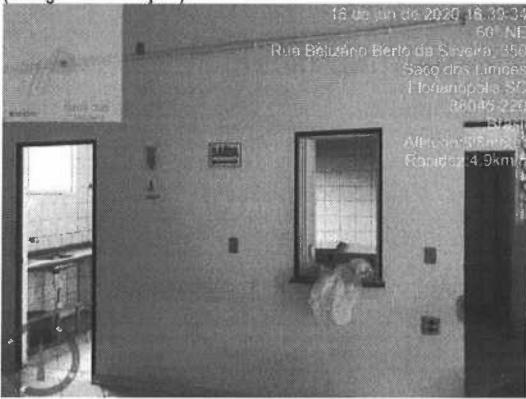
e 46 – Hall e cozinha. Segundo pavimento do edifício dos fundos (antiga associação).
